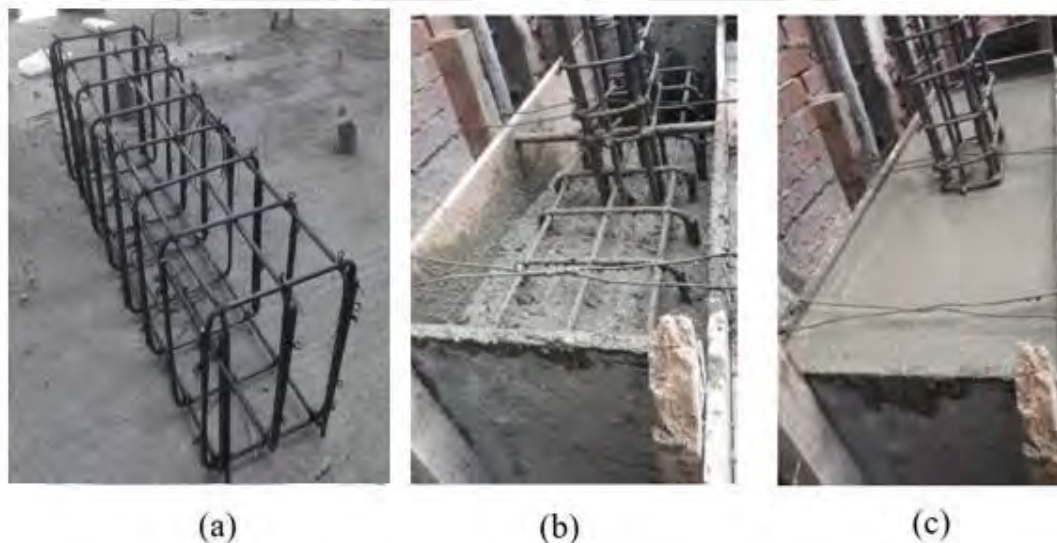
Construcción de zapata: (a) Armado de acero de refuerzo, (b) Colocado de concreto $F'c = 210 \text{ kg/cm}^2$, (c) acabado final de zapata. (Fuente: Propia)
